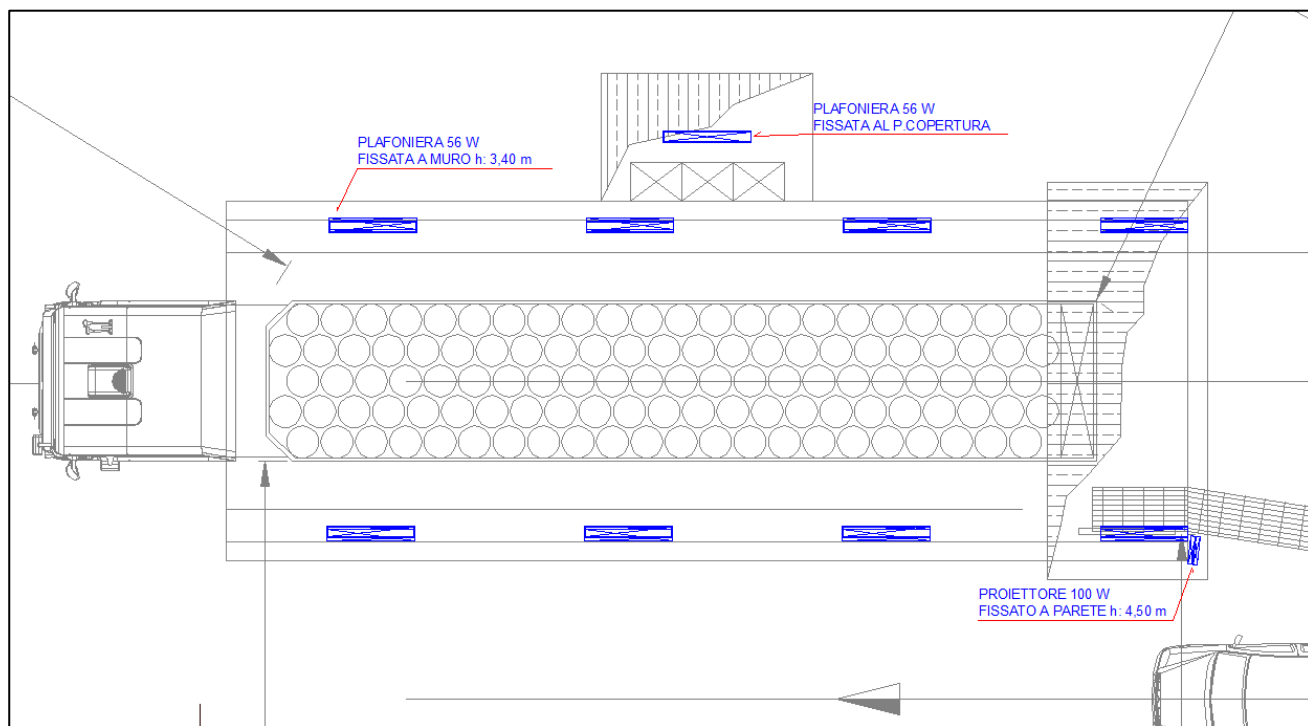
Dettaglio disposizione apparecchi Zona Carro Bombolaio
